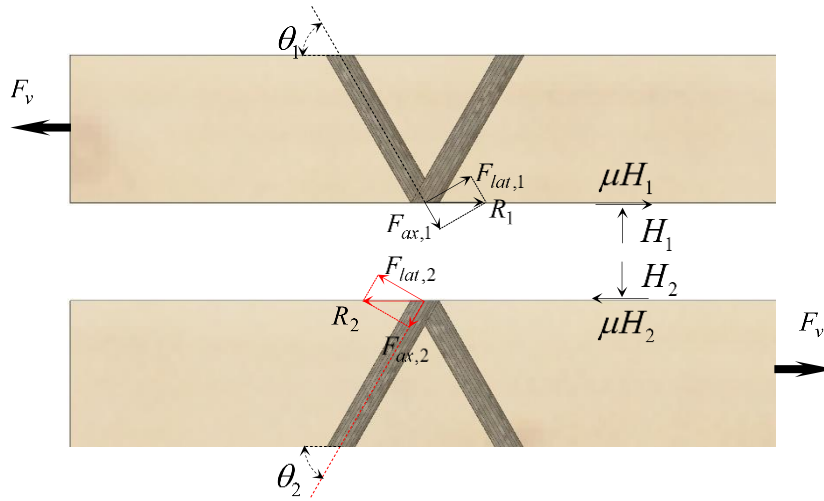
Fonctionnement mécanique d'un assemblage plan constitué de deux vis disposées en X par rapport au plan de cisaillement
